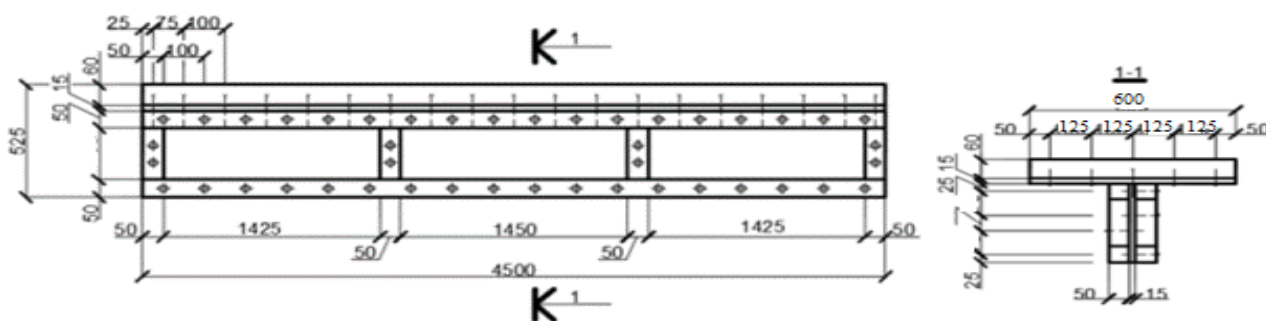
Конструктивне рішення деревогрунтобетонного перекриття
